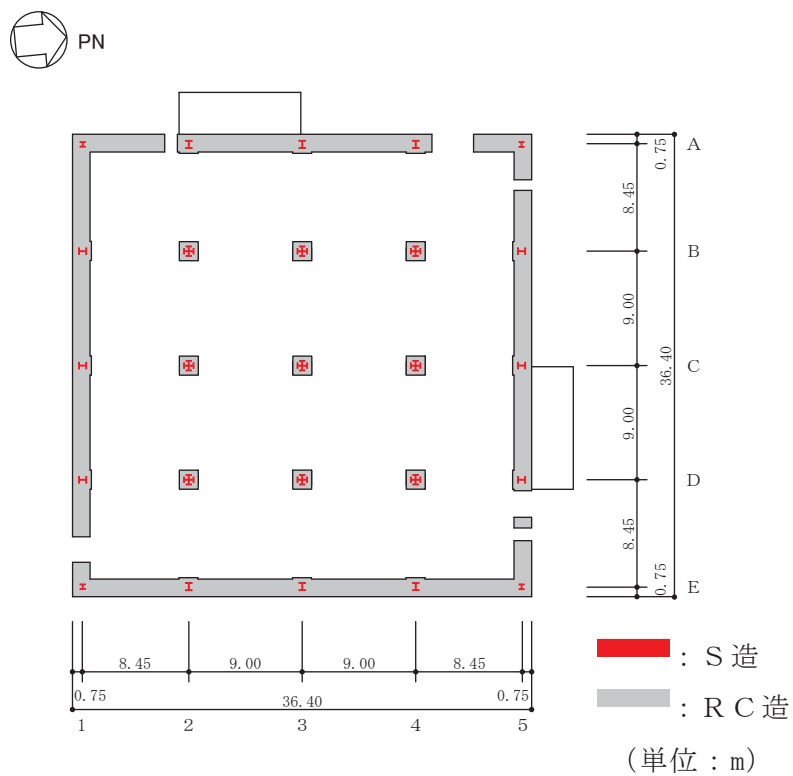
(3) 緊急時対策建屋の概略平面図 (0.P. 62.2m)
